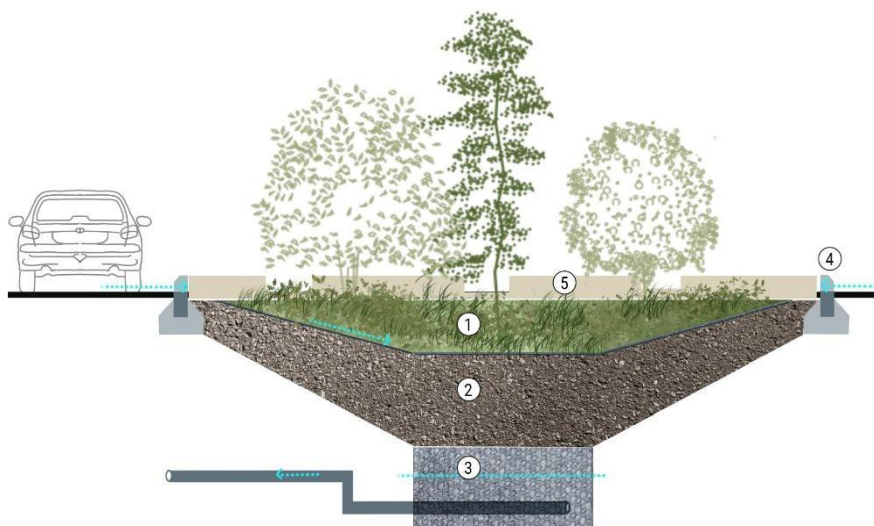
Detaliere de amenajare zone umede la nivelul străzilor. 1 - zonă umedă amenajată la nivelul străzilor; 2 - sistem de drenaj din pietriș grosier sau piatră spartă; 3 – tub sau tuburi de drenaj cu diametru mai mare de 80 mm, prevăzut cu sistem de evacuare a apei către canalizare sau elemente de stocare, pozate în straturi din pietriș grosier sau piatră spartă; 4 - sistem pietonal sau rutier cu borduri prevăzute cu guri de scurgere la partea inferioară pentru a permite scurgerea apei pluviale către zona umedă; 5 - zid separator între zone umede succesive.
